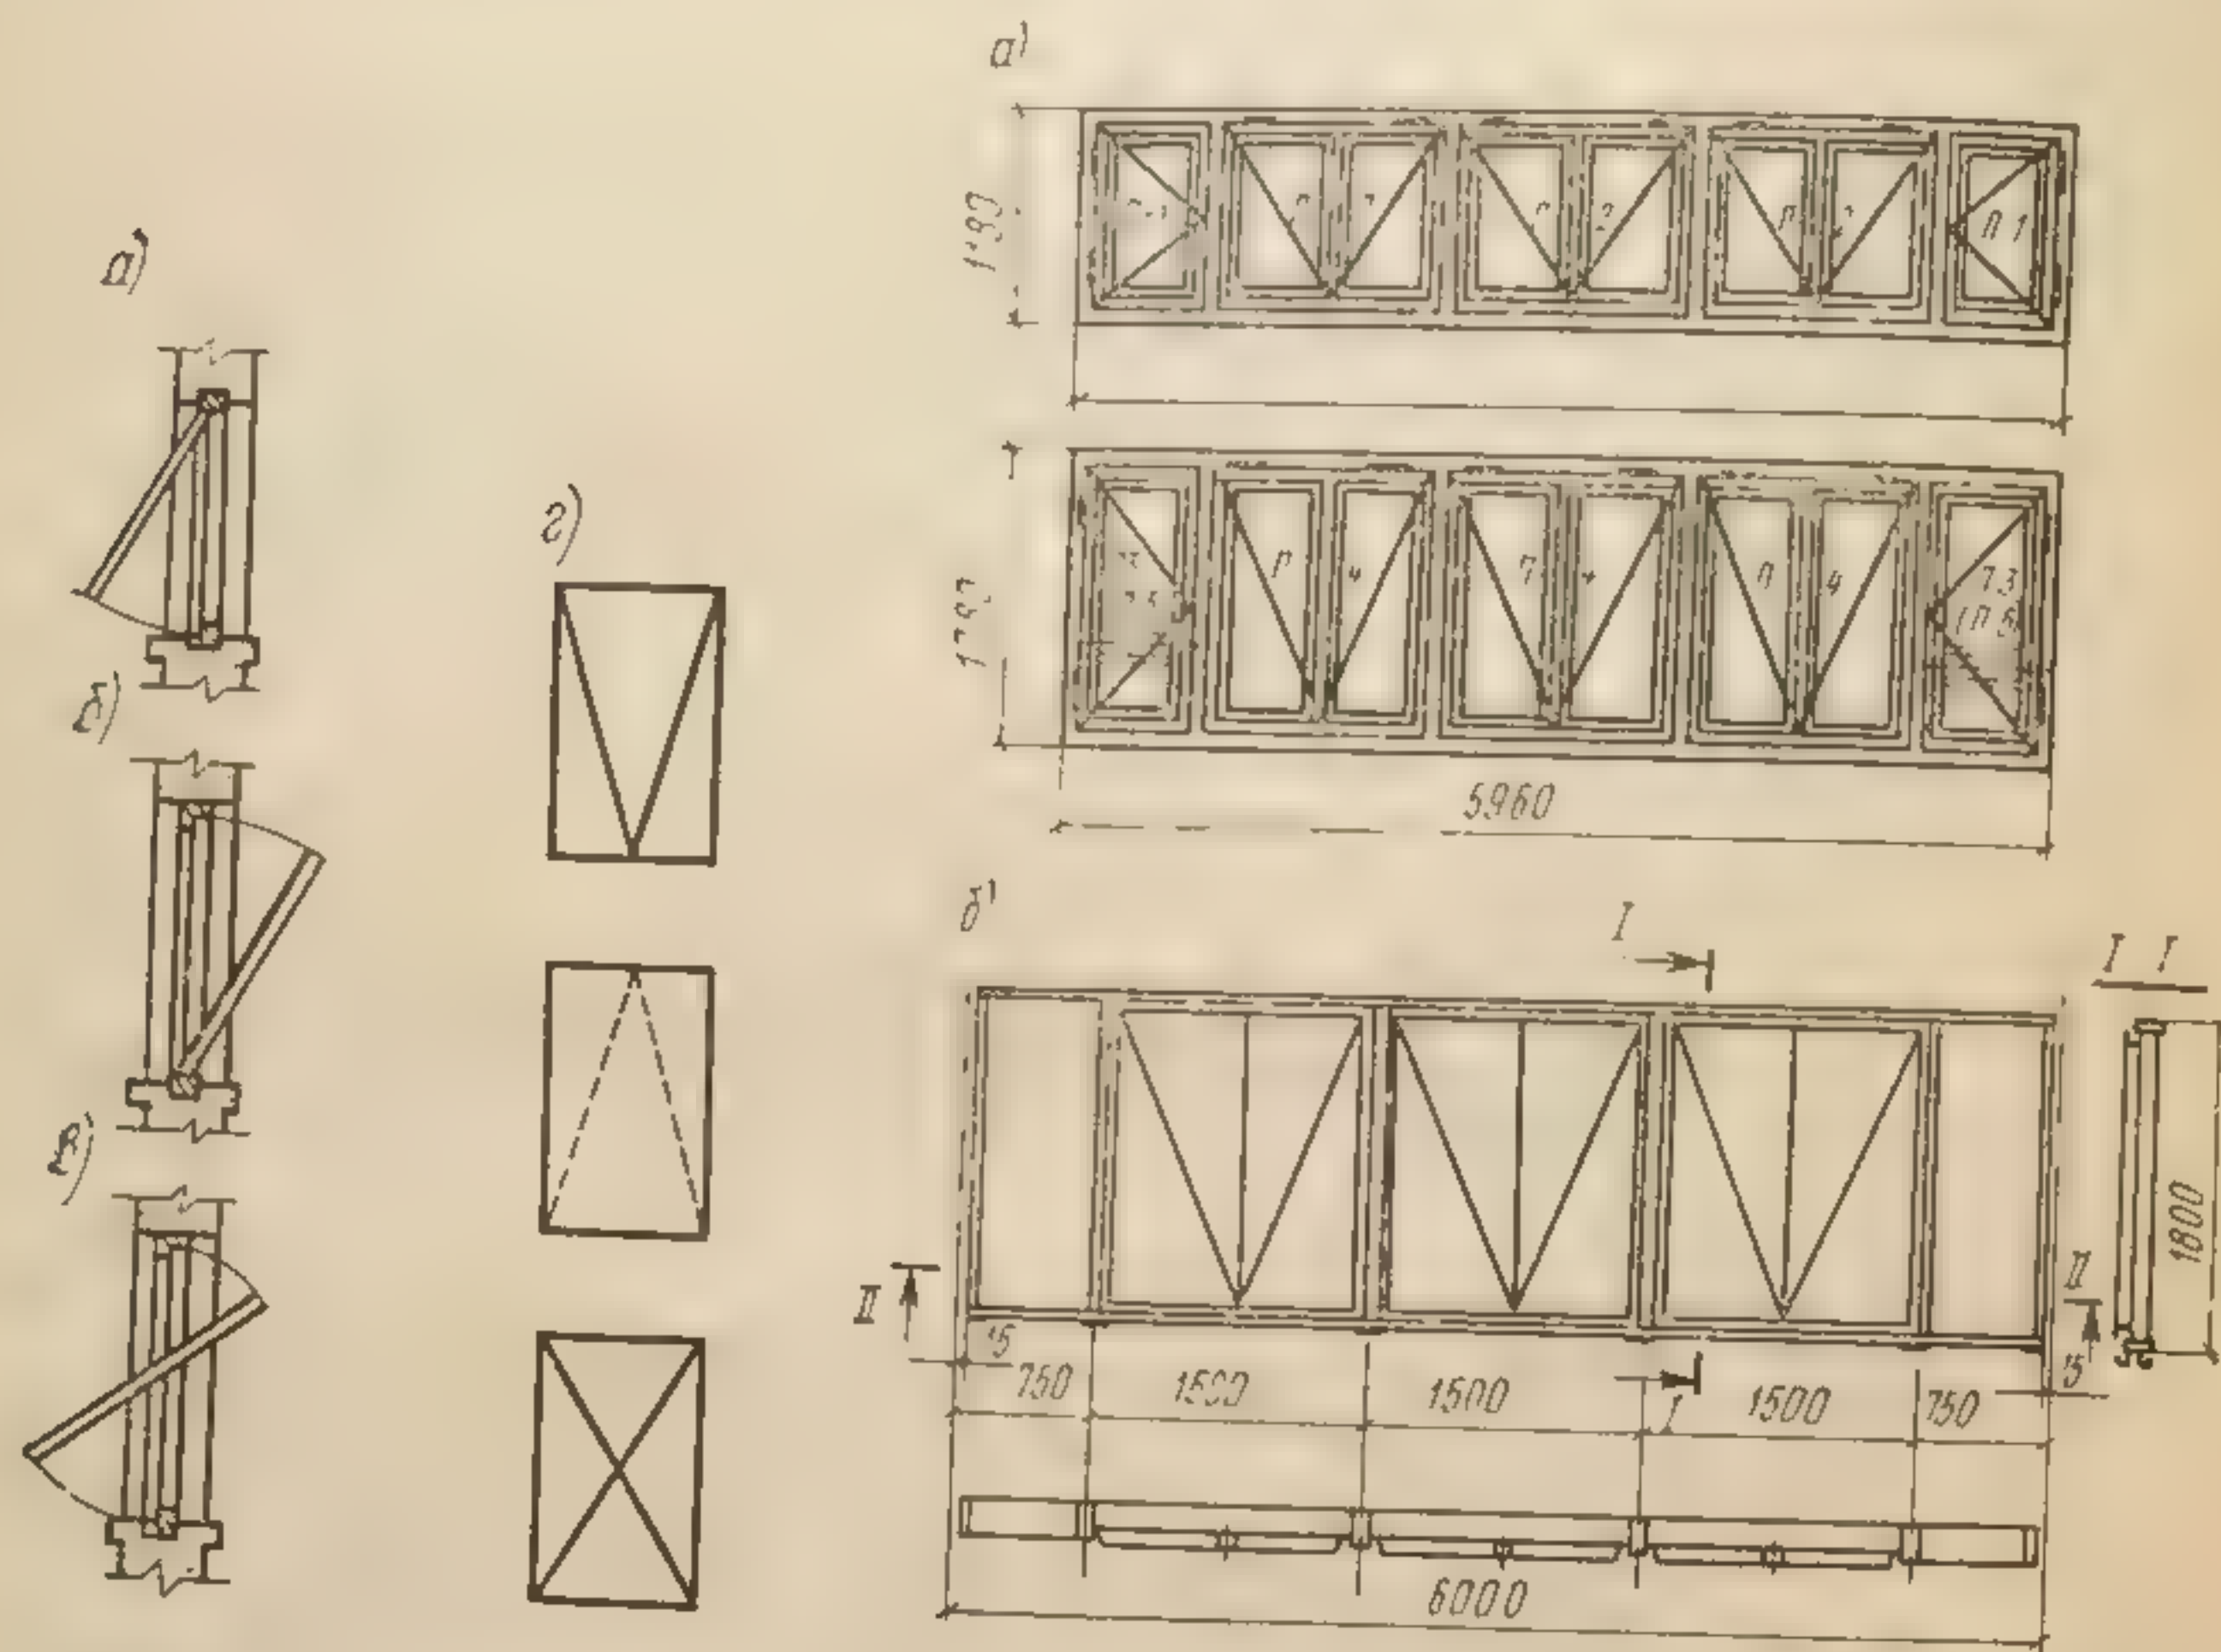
Схемы оконных переплетов промышленных зданий:
